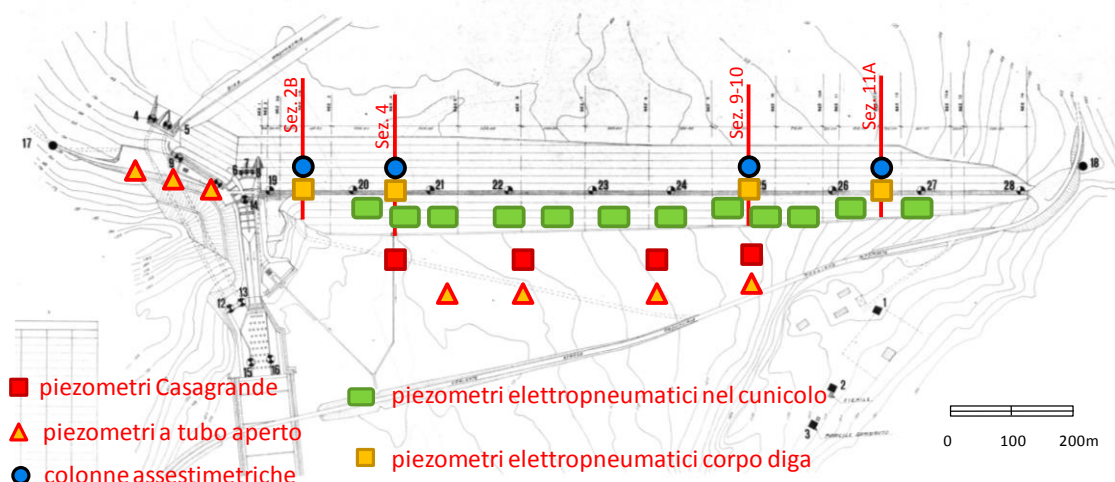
Vista planimetrica del sistema di monitoraggio della diga
